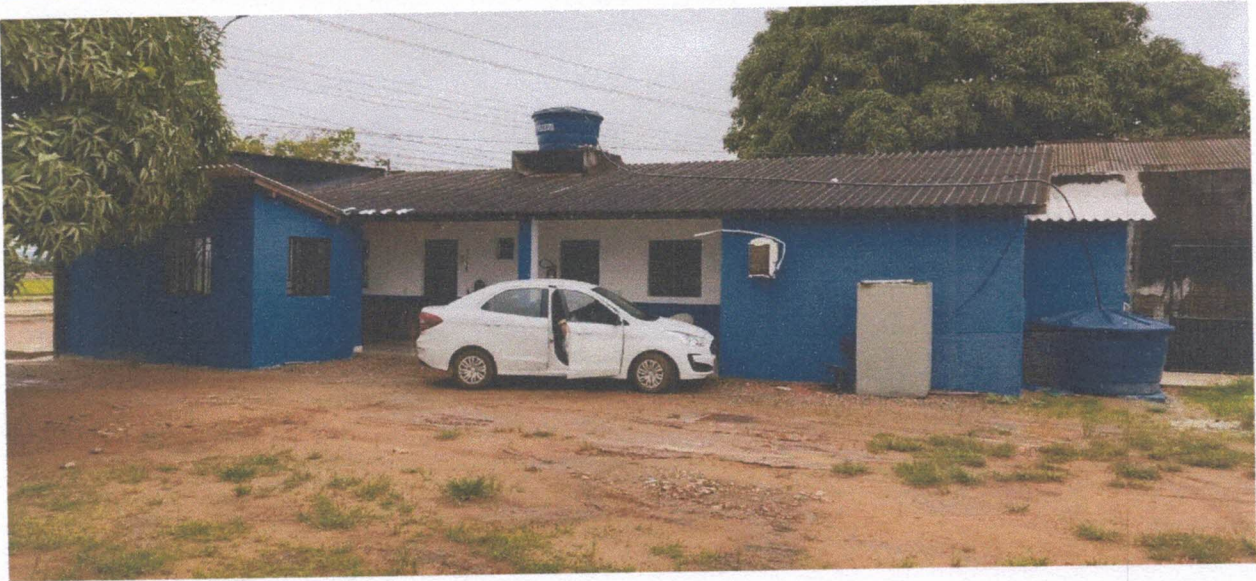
Externo – Cobertura – Sistema de vedação/Alvenaria – Caixa D'água.
